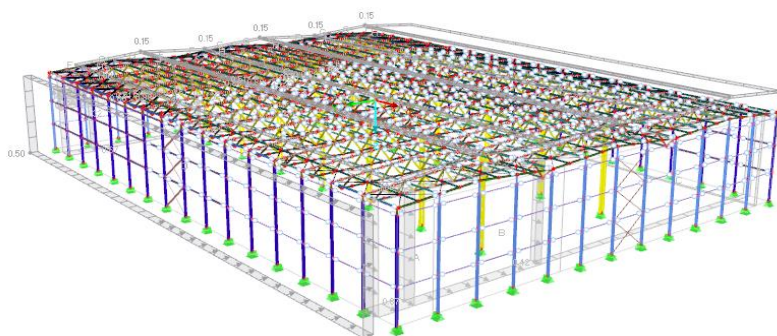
Ветровая нагрузка вдоль цифровых осей
